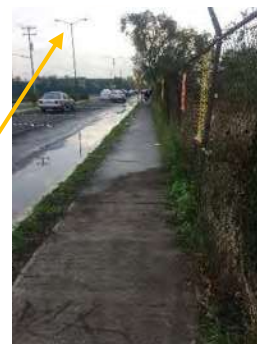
Pavimento de las calles de acceso al predio. Tomada por Ilse Cahue.
